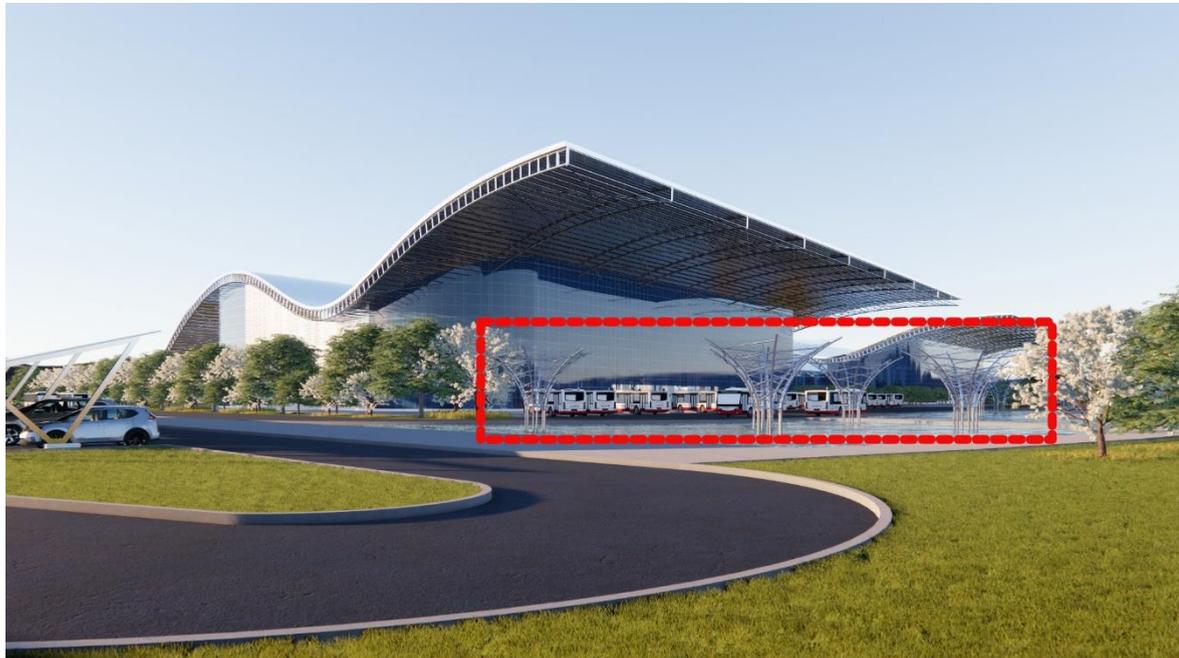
Aplicación de material impermeable como acero galvanizado vista 1
